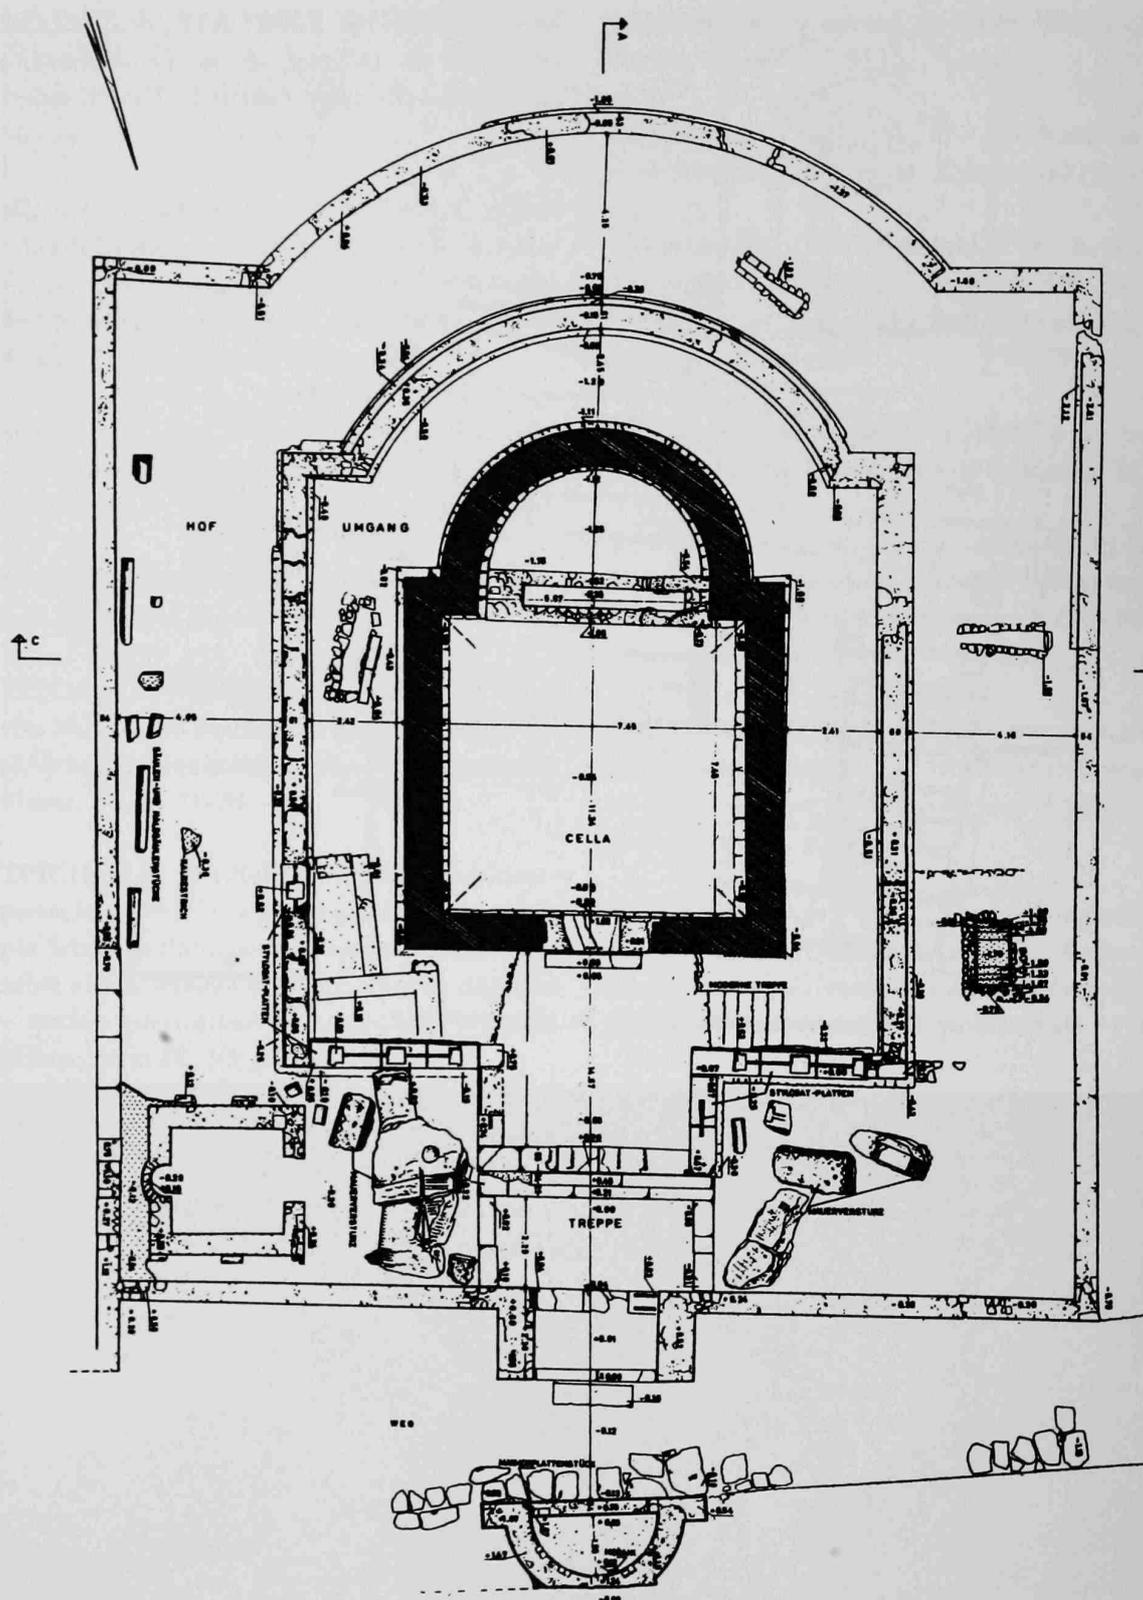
Milreu, planta do edifício da construção central, elaborada por Th. Hauschild.
